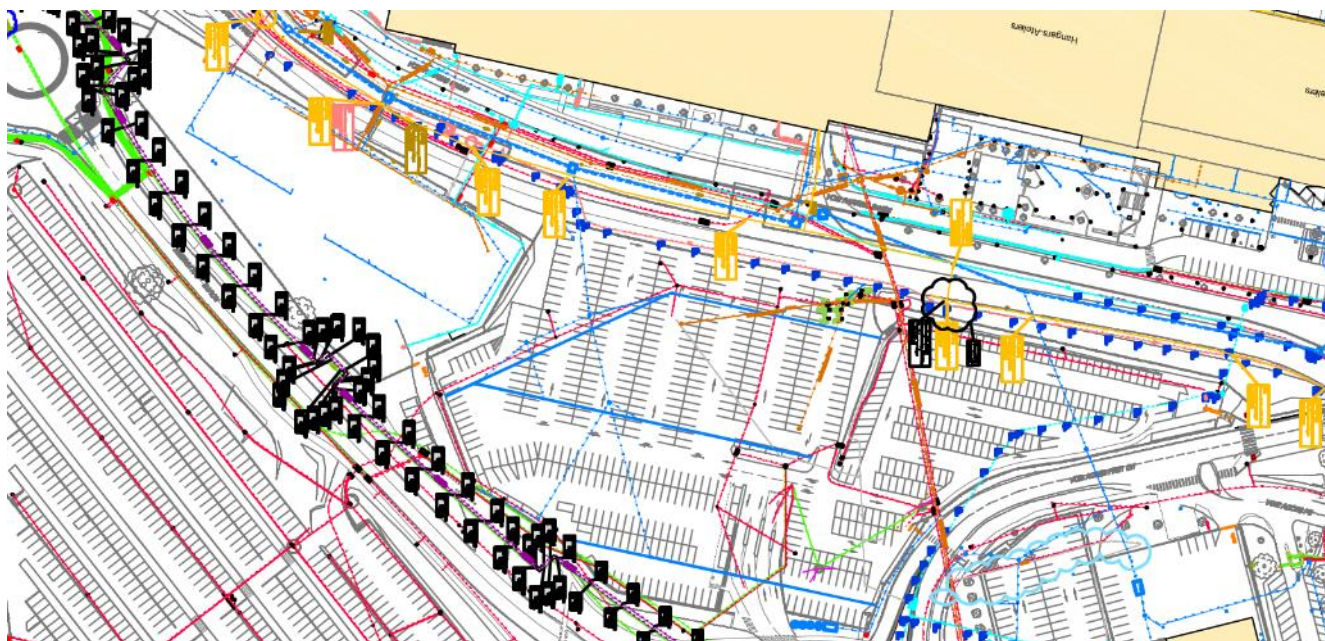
Extrait du plan des réseaux sur l'emprise du parking S13 existant et du site en extension (Jet Aviation)
